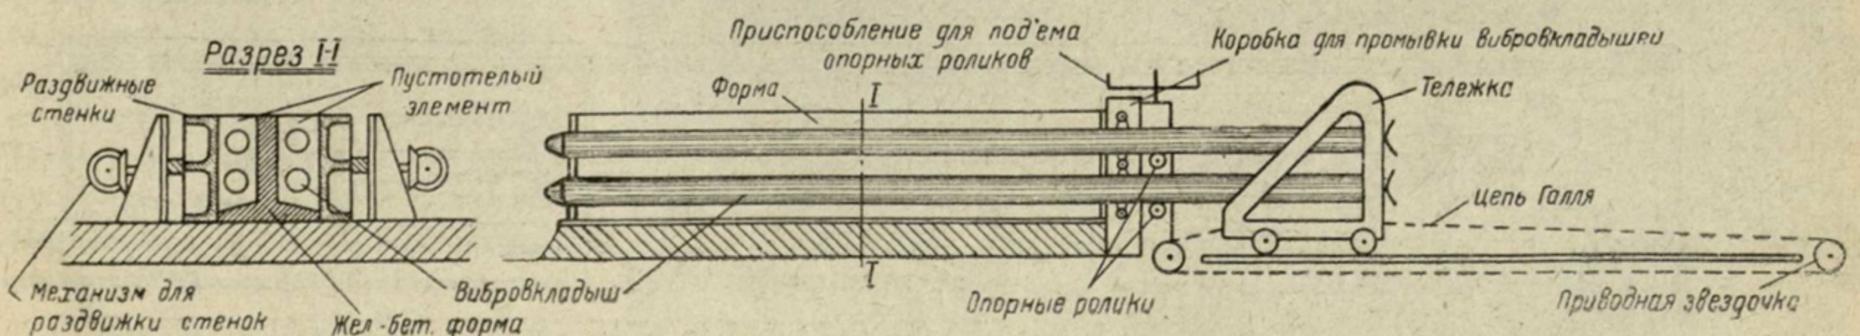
Схема станка с подвижными вибровкладышами, принятая для завода № 6 Треста блочного строительства.
